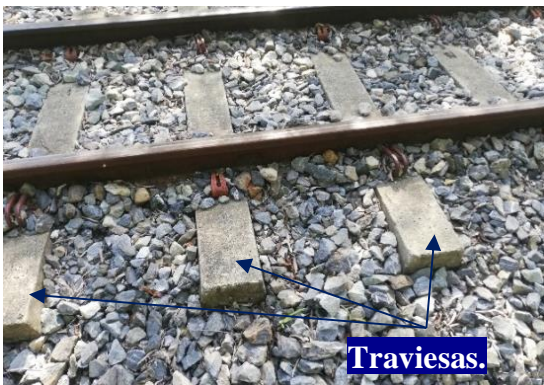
Traviesas de concreto. Puerto Sogamoso.
